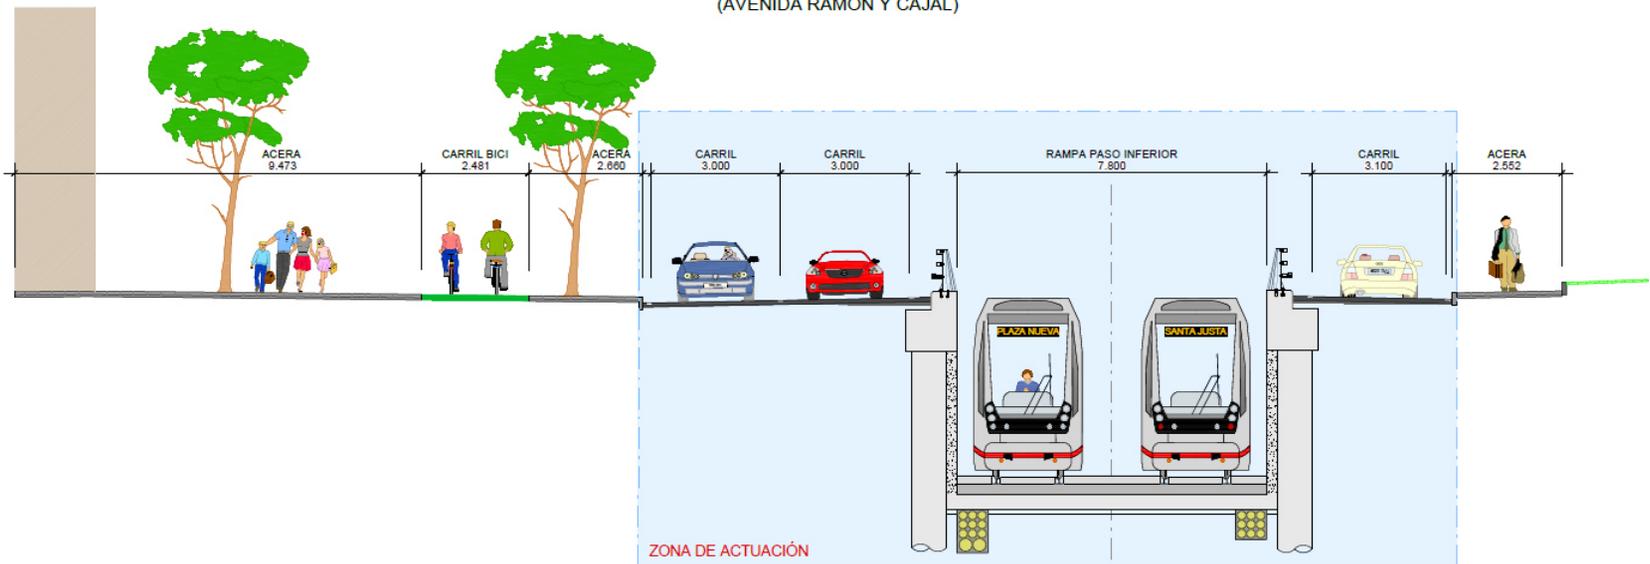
Extracto del proyecto, plano 2.5: reducción de acerados en la calle Ramón y Cajal.
